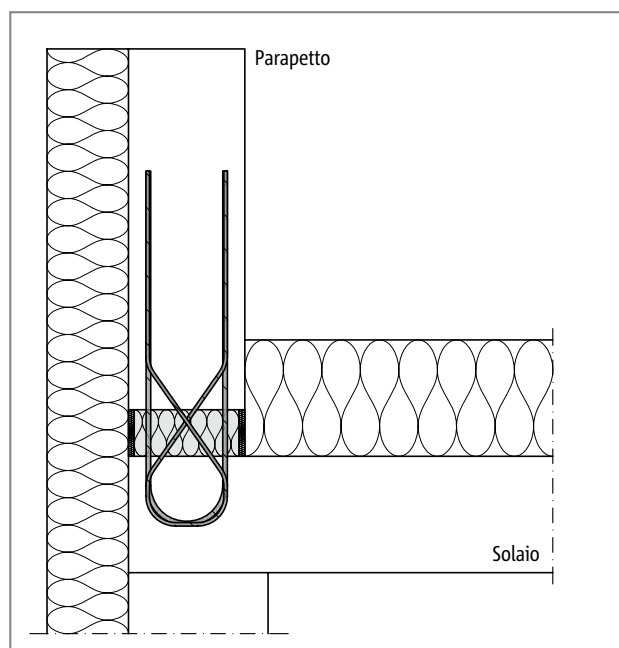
Schöck Isokorb® T tipo AP disposizione verticale: raccordo di un cornicione
